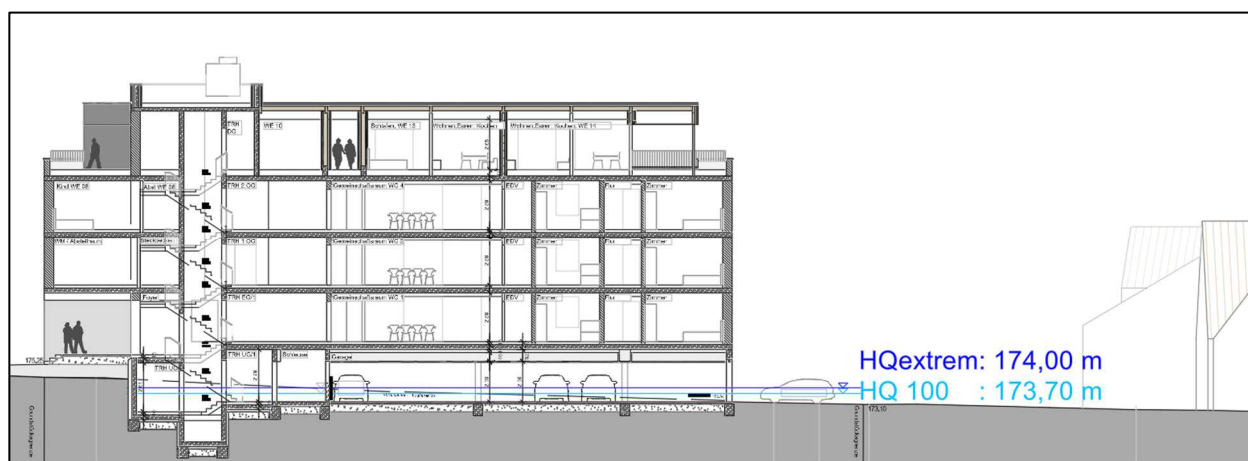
Schnitt gepl. Gebäude mit HW-Wasserspiegellagen
